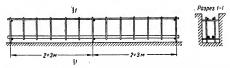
Арматурный каркас балки с упорами в виде удлиненных поперечных стержней.
